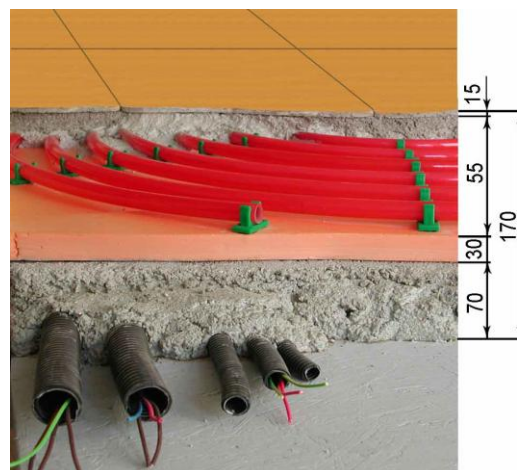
SEZIONE IMPIANTO DI RISCALDAMENTO/RAFFRESCAMENTO A PAVIMENTO
